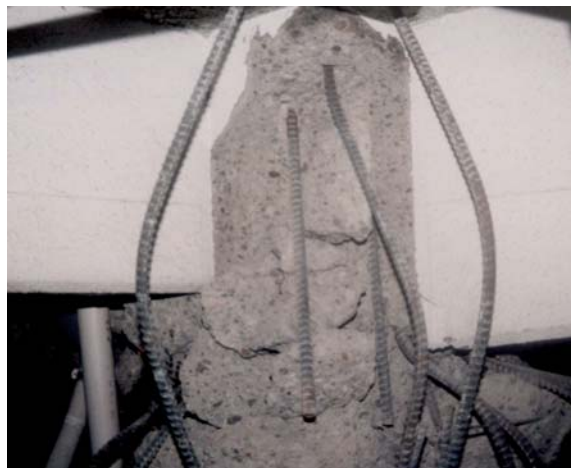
柱梁接合部に横補強筋が配筋されていないため、柱主筋に沿う付着割裂ひび割れが生じたコンクリートが剥落。
